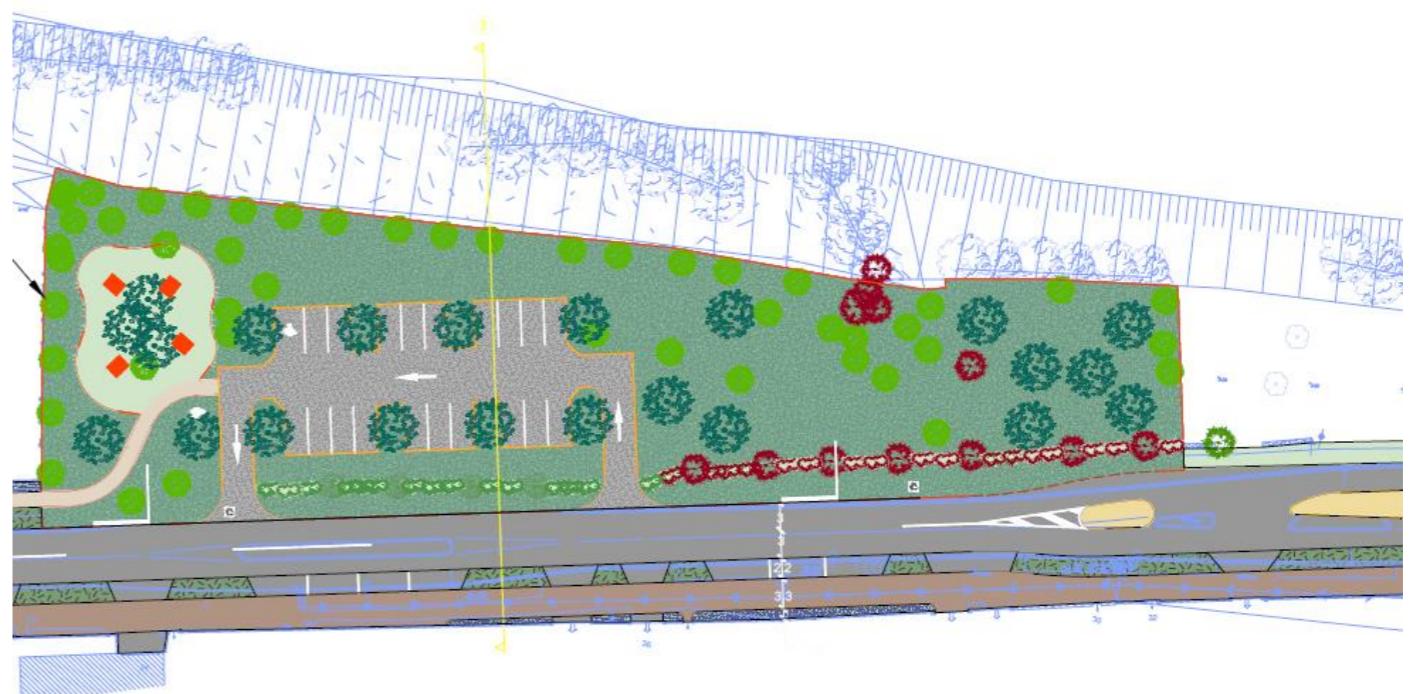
Aménagement autour des zones de parking prévues sur L'Île-d'Elle (Source : Plan des aménagements)
